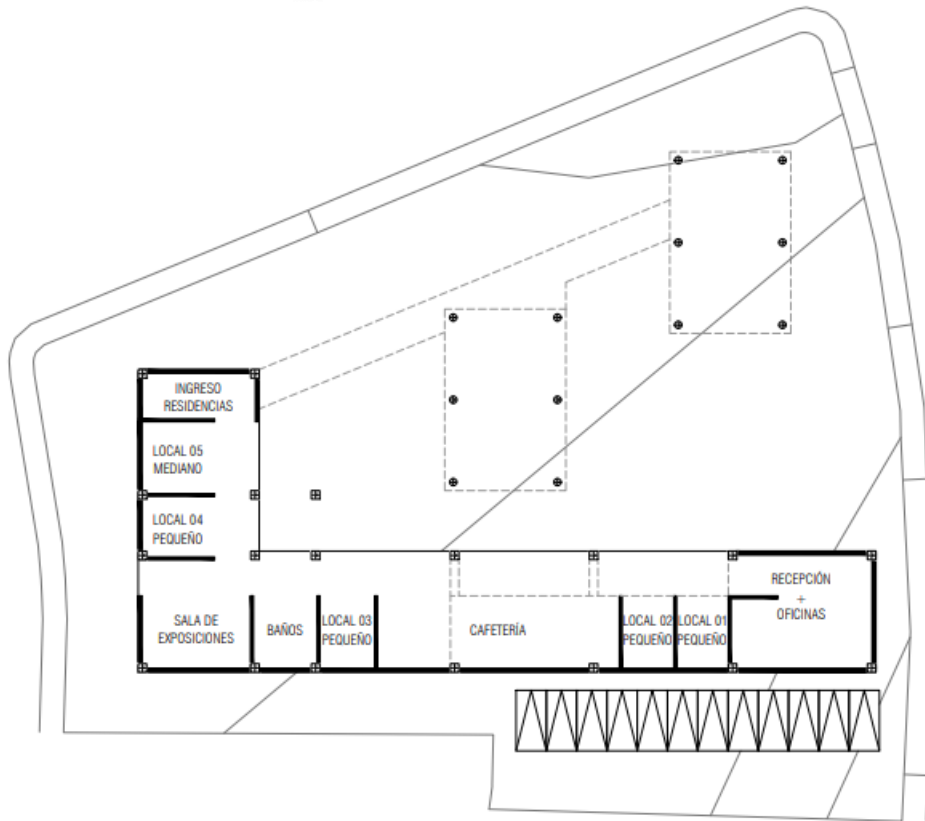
Planta baja - Anteproyecto 01. Elaboración propia.
